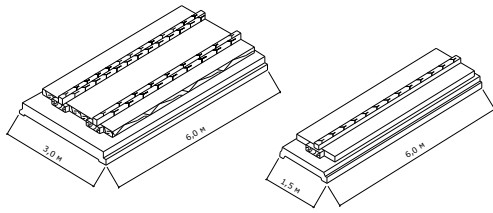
Комплексні залізобетонні плити вентиляційних покриттів
